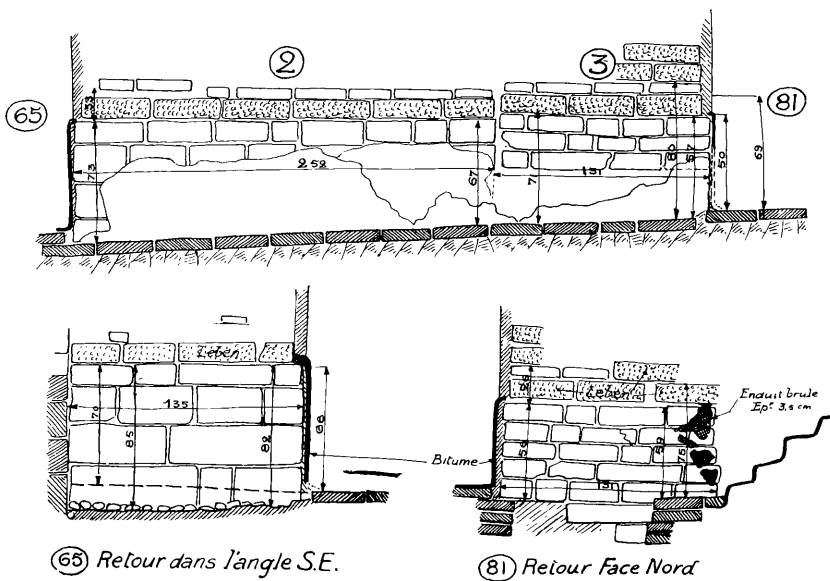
Passage 65-81. Détail des soubassements en pierre, mur est.
